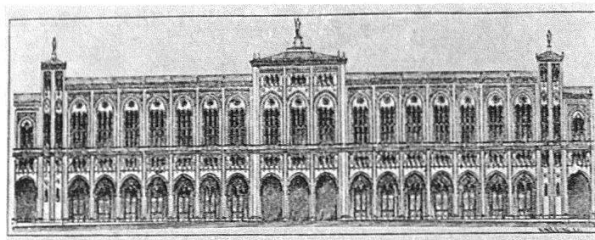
München. Königliches Regierungsgebäude, jetzt Regierung von Oberbayern. Fassadenplan von Friedrich Bürklein, 1854. Erbaut 1856–1864
